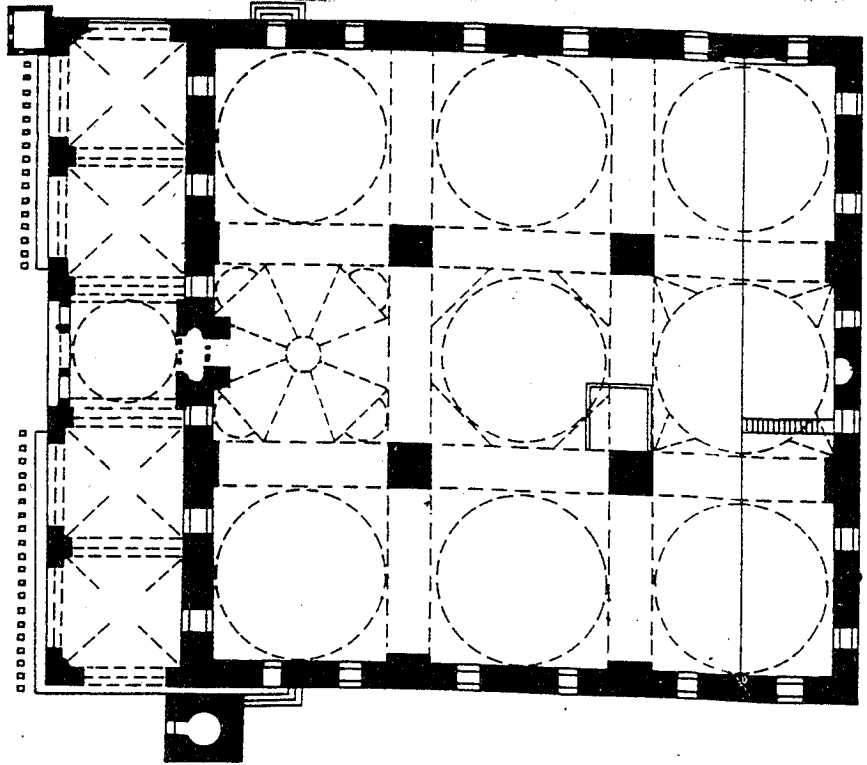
المسقط الأفقي للطابق الأرضي لمسجد رشيد باشا ببهازي
